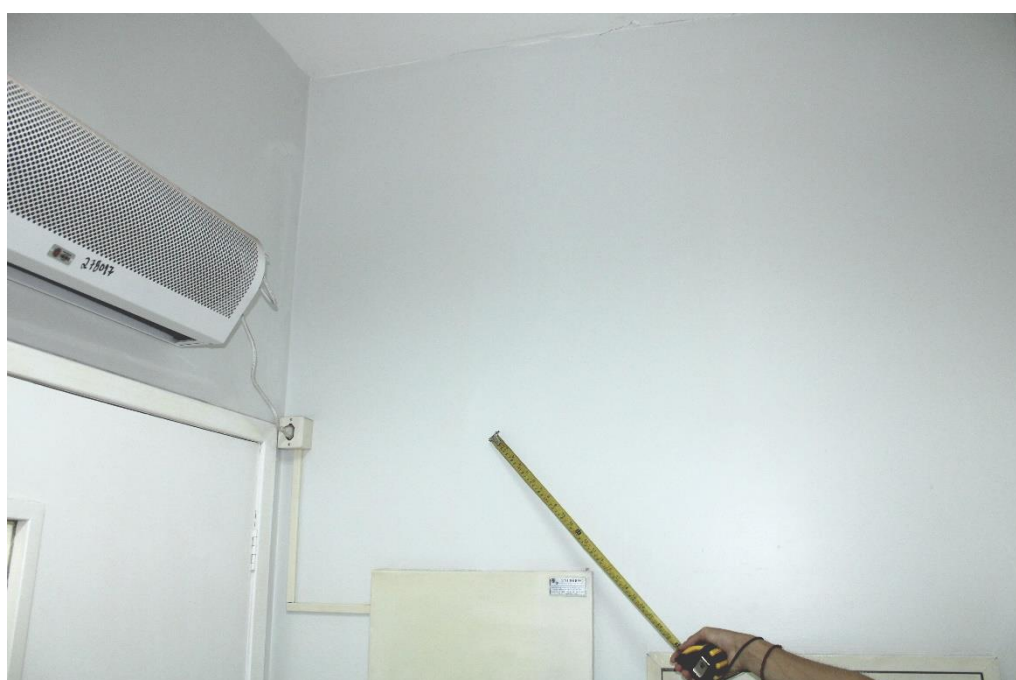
Vista parcial da recepção do CTA, destacando sinais de reparos em alvenaria.
